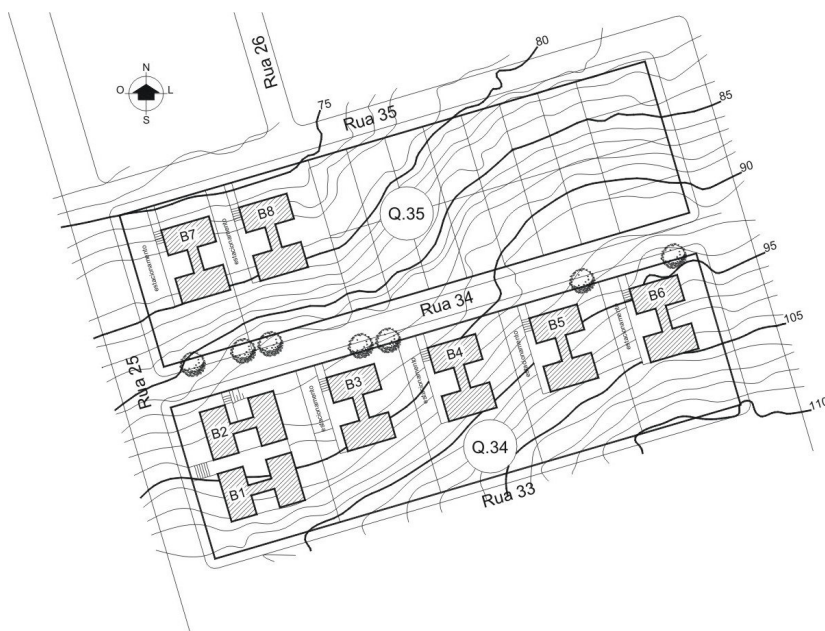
Planta de implantação (Fonte: HERMSDORFF, 2005).
